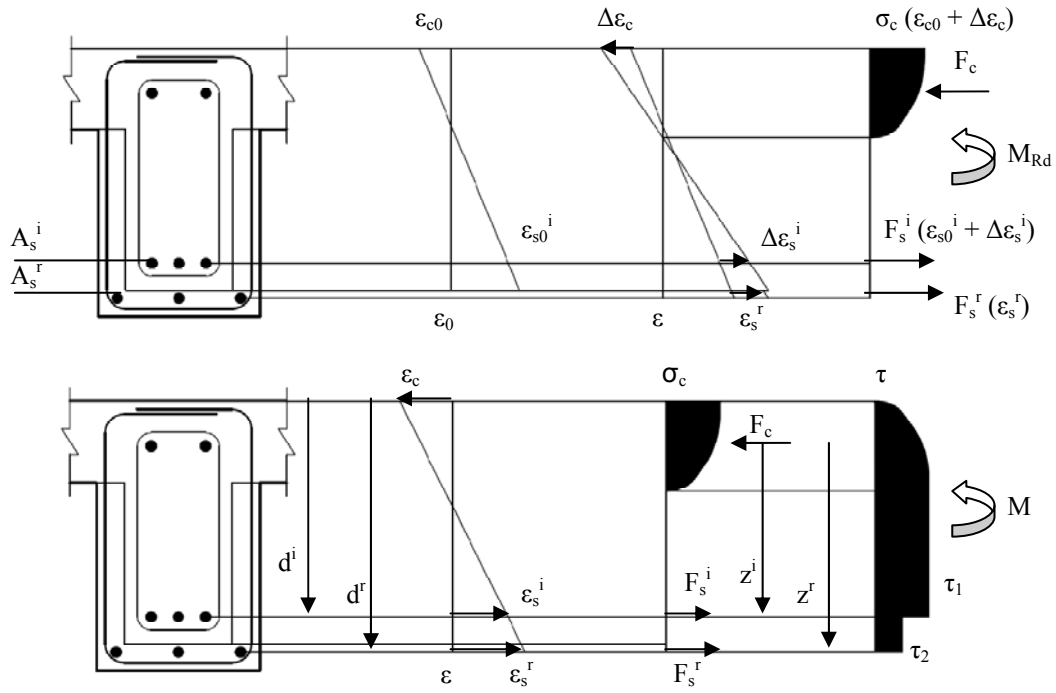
Cálculo do momento resistente e tensões de corte numa secção reforçada por adição de betão armado, adaptado de [7]
